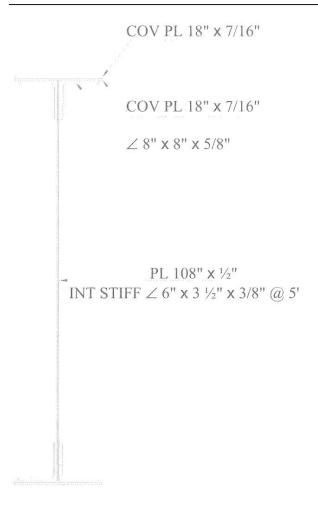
Sección transversal de viga en la mitad del claro
